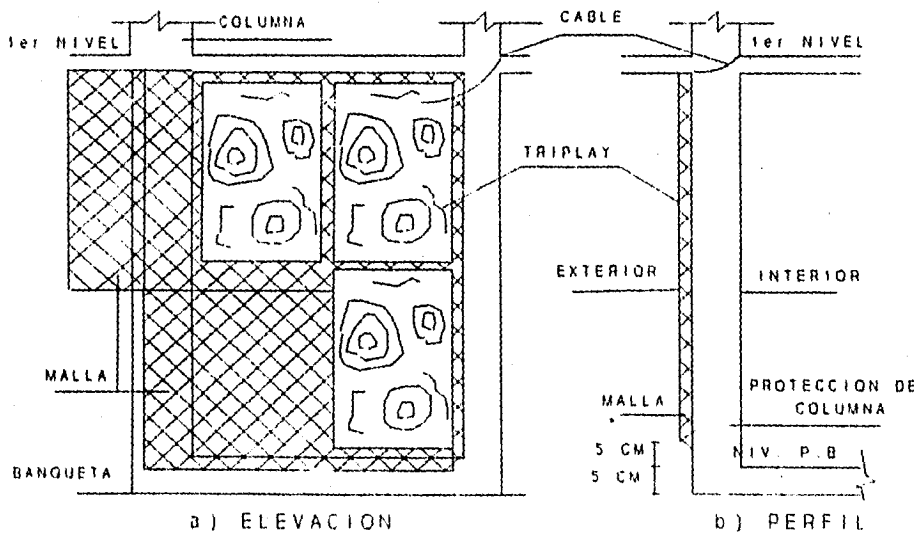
PROTECCIÓN EXTERIOR EN LA PLANTA BAJA
